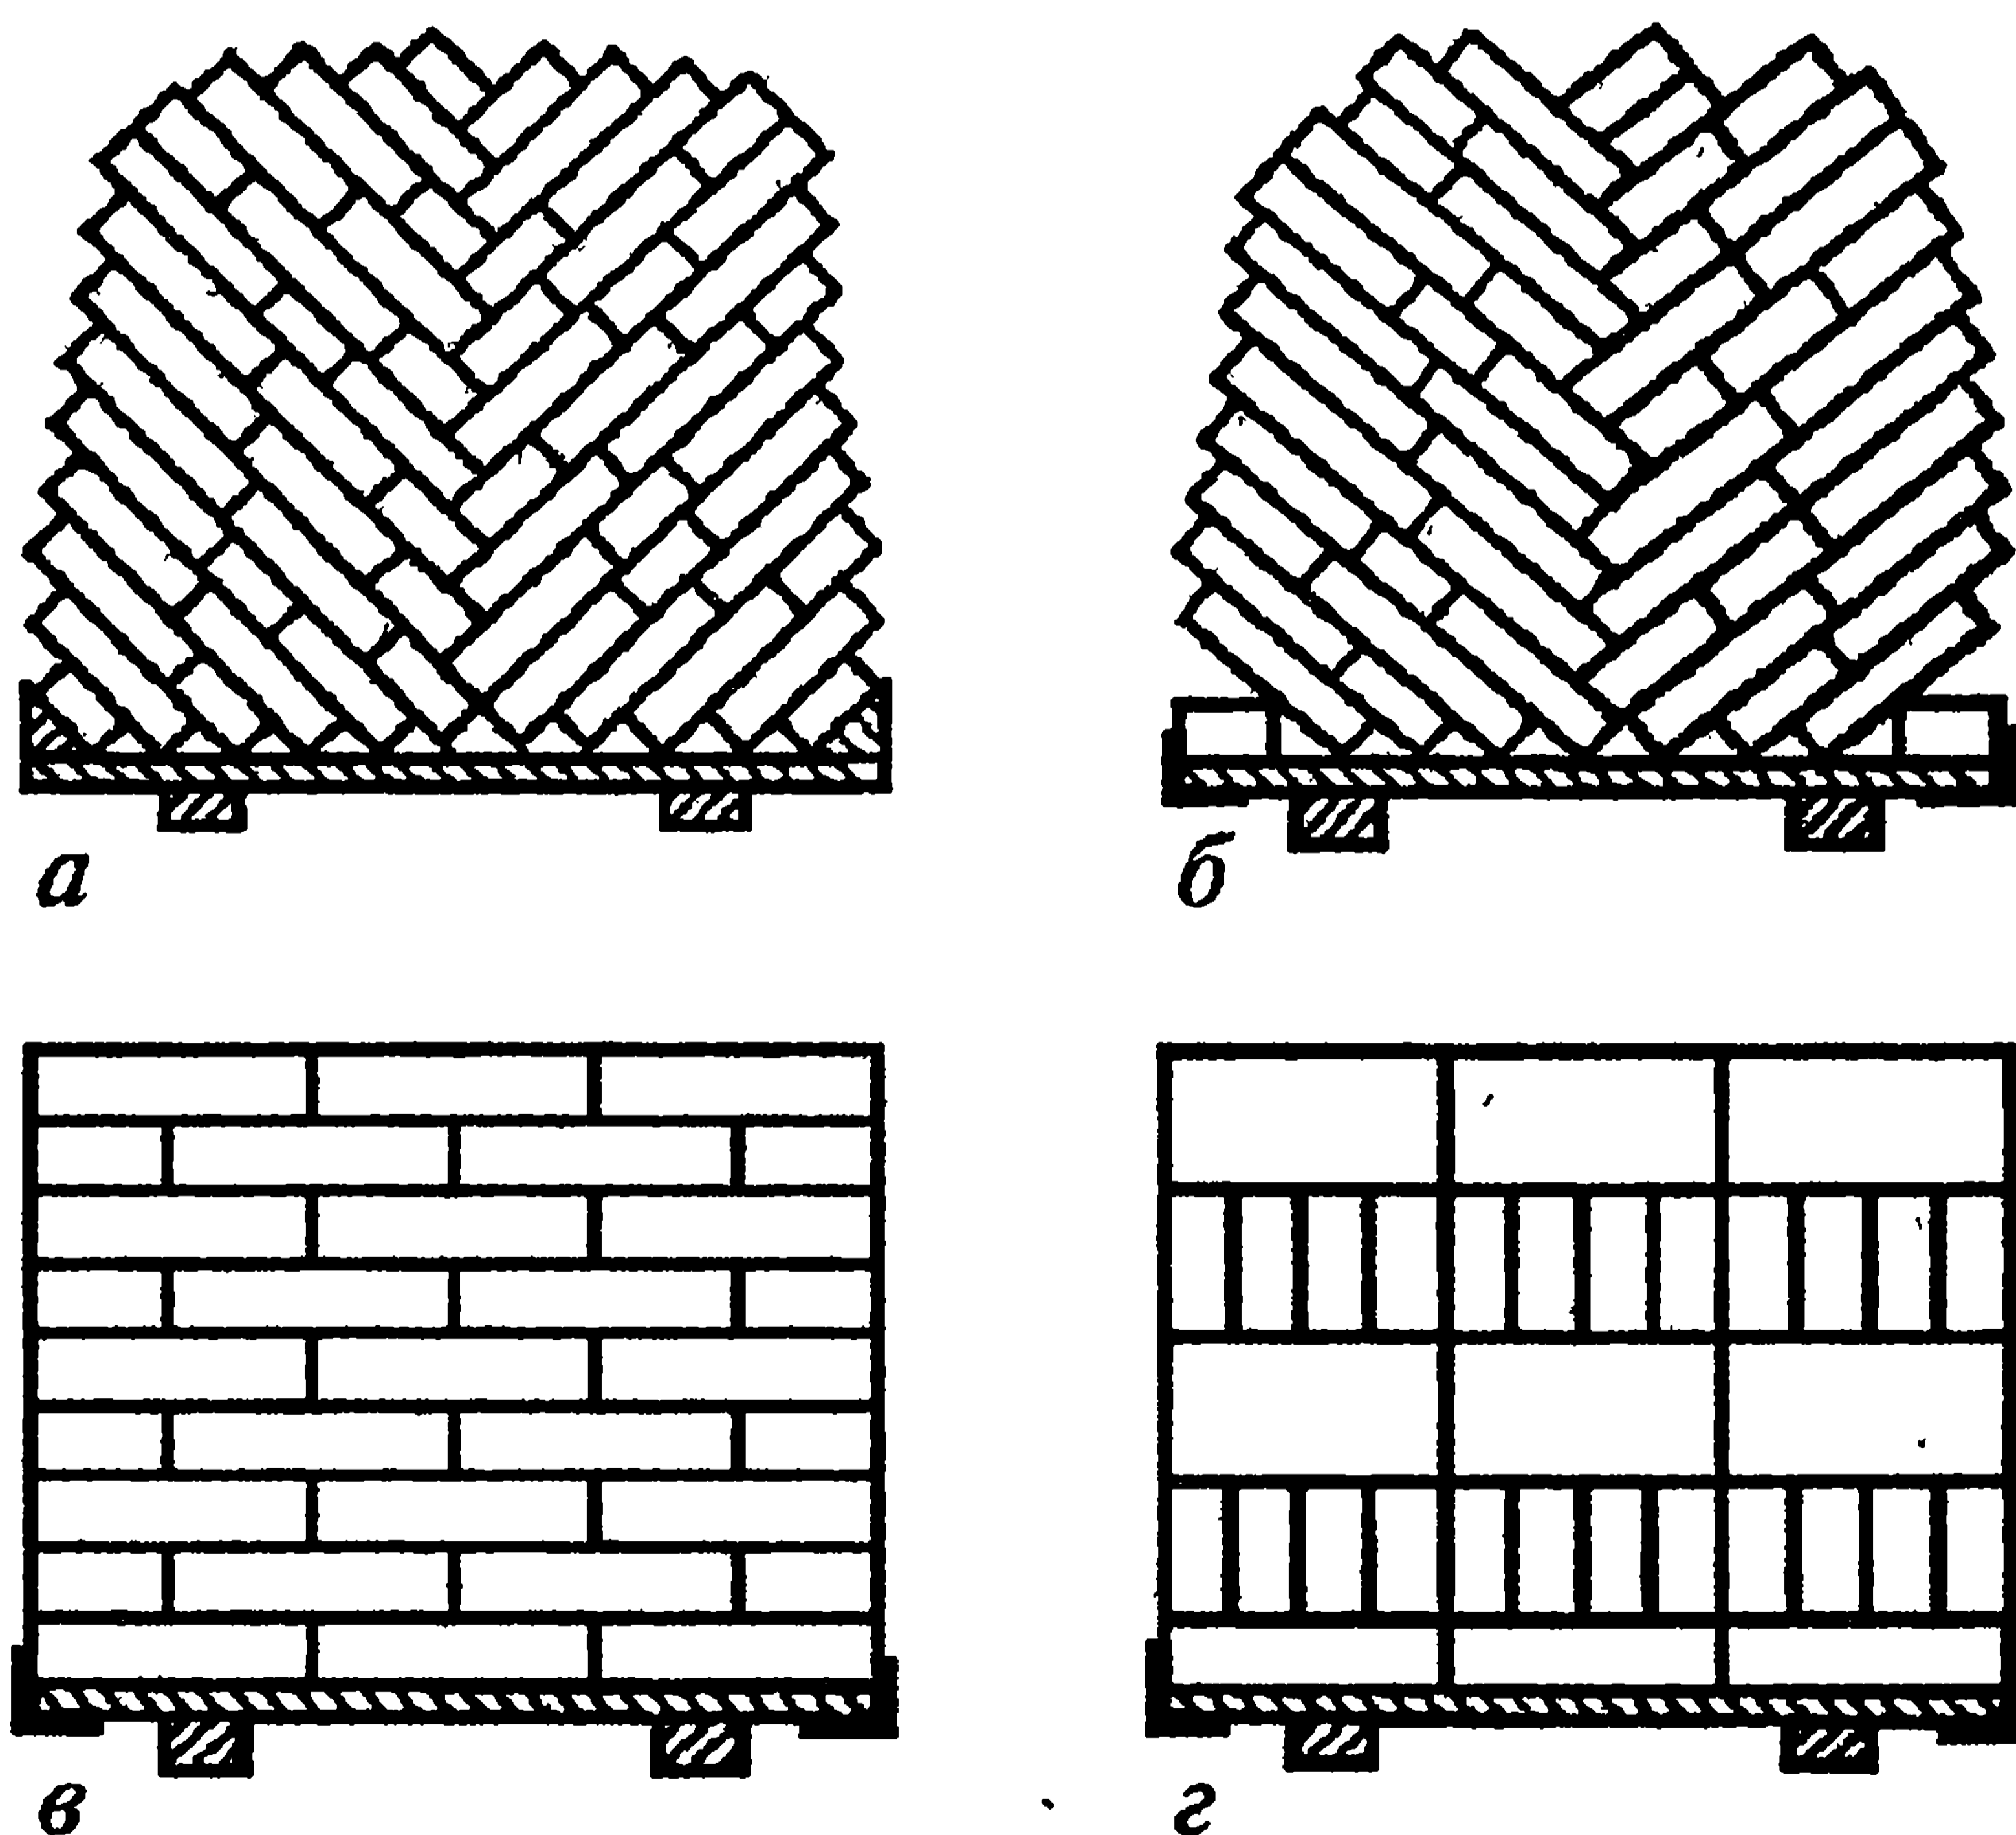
Схема укладки кирпича пакетами на поддоны:
